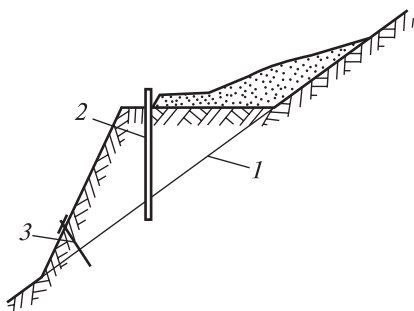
Берма откоса, укрепленная штангой и железобетонной свай:
